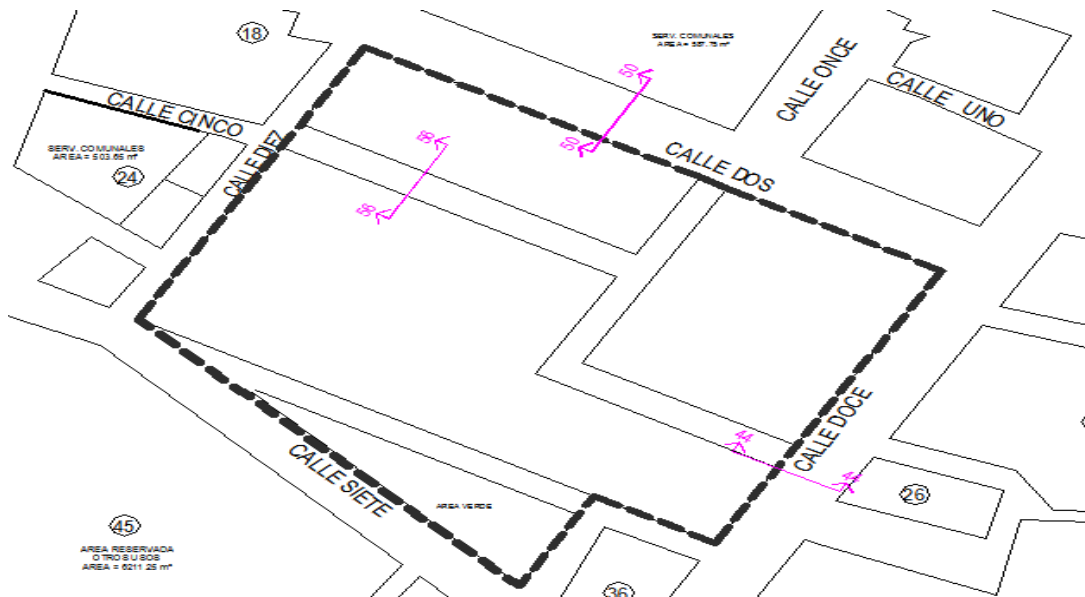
Planta de secciones de calles y tipos de pavimentos
